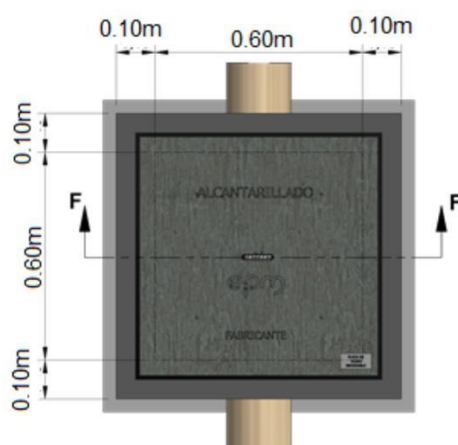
Caja de inspección – Vista en planta. Fuente. EPM, 2019.
